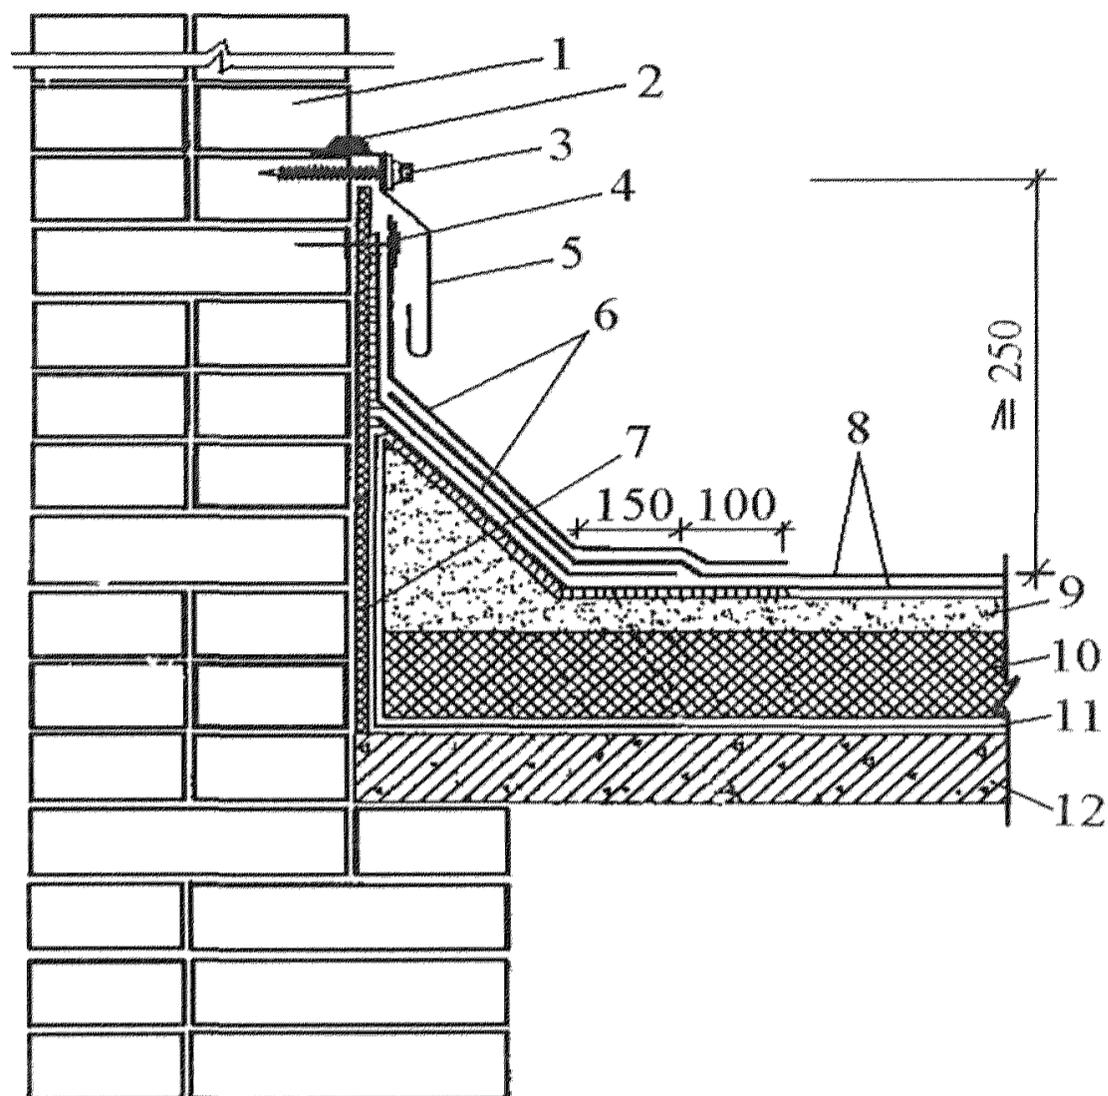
Пример примыкания водоизоляционного ковра к кирпичной стене:
